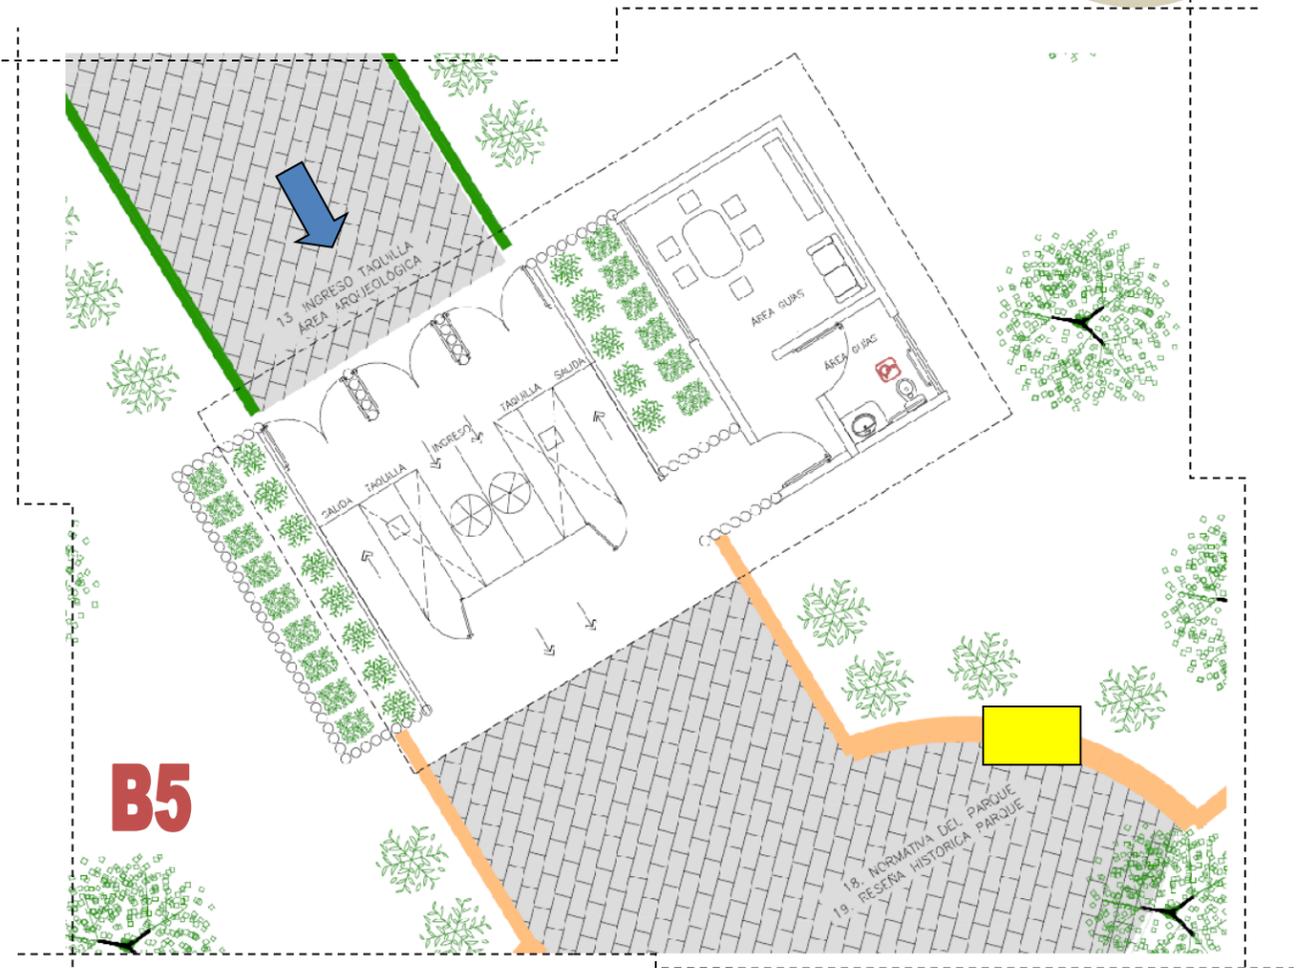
Planta Propuesta de área de servicios al visitante
